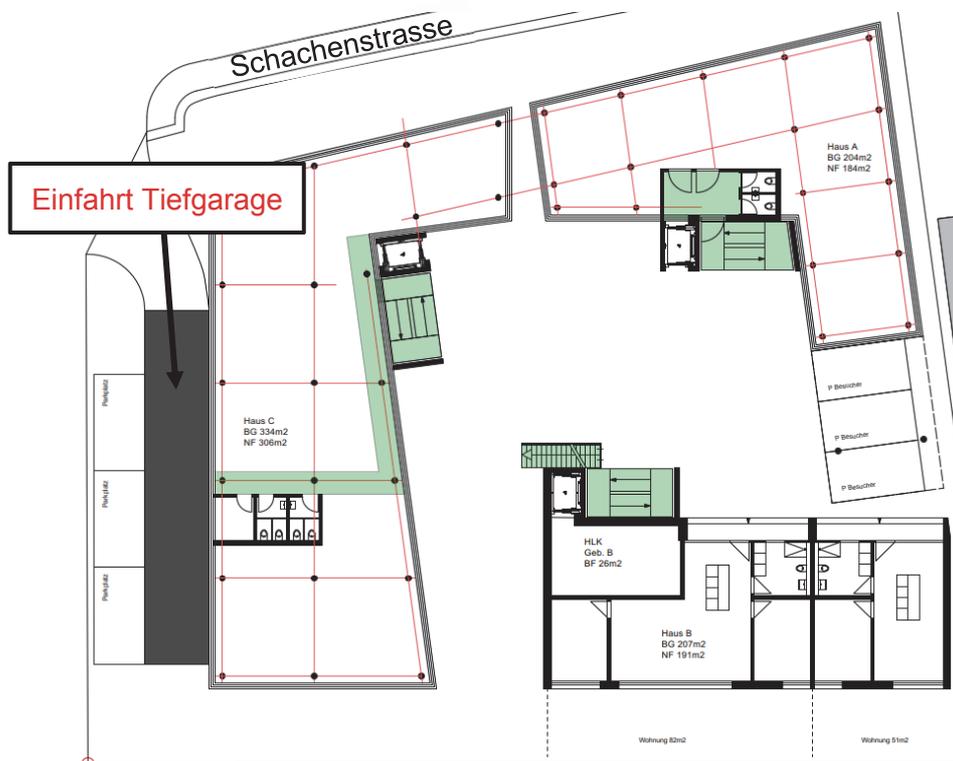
Grundriss EG [1]. Die Bodenplatte weist eine Kote von 519.79 m ü. M. auf.
